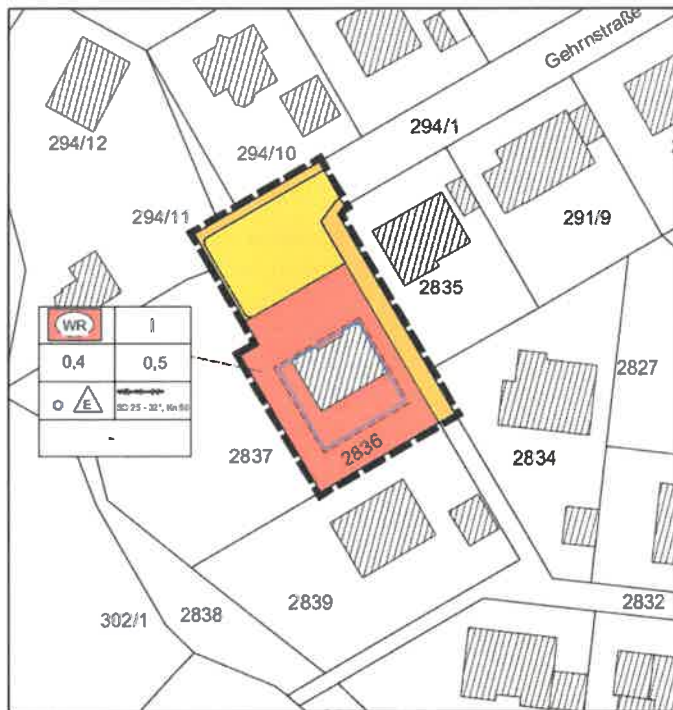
Entwurf Bebauungsplan „Steinacker, 3. Änderung“, Fritz & Grossmann – Umweltplanung GmbH, Balingen, 11/2020
